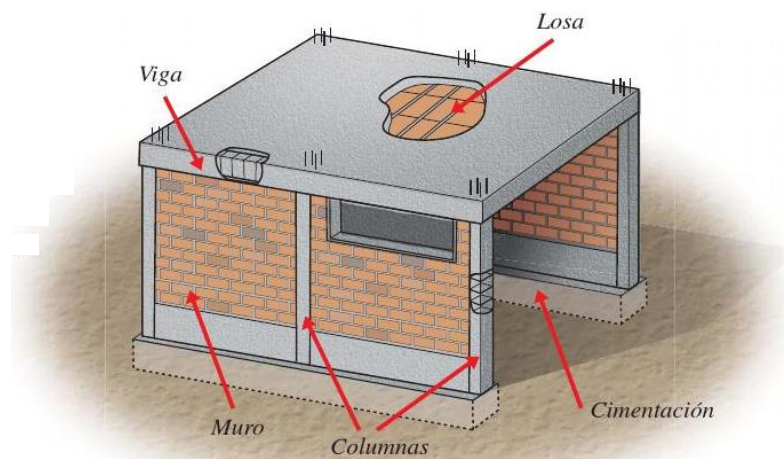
Elementos estructurales en una vivienda de albañilería confinada
